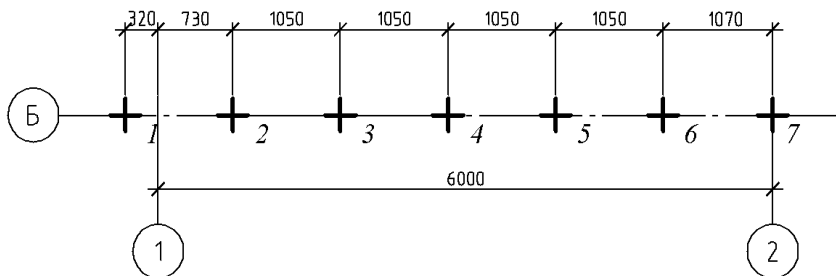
Пример оформления плана свай ленточного свайного фундамента
